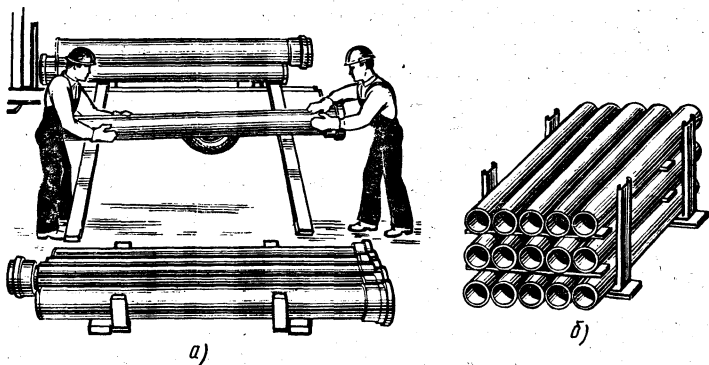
Разгрузка (а) и хранение (б) пластмассовых труб
